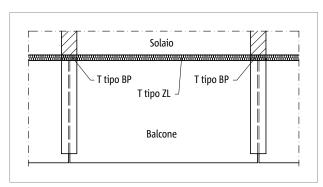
Schöck Isokorb® T tipo BP: balcone con travi sporgenti verso il basso a sbalzo (balcone prefabbricato)
